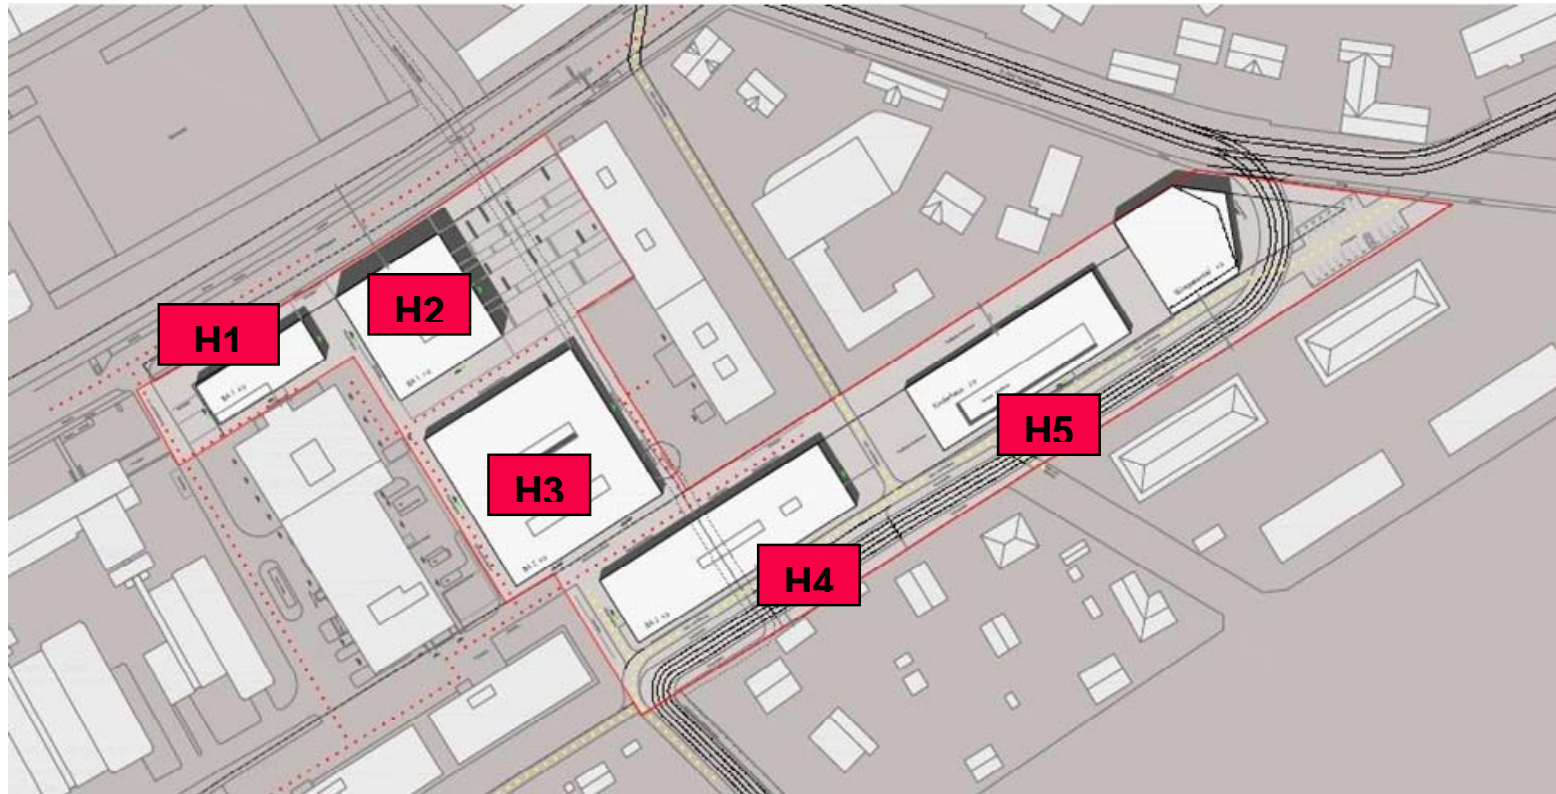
Grundrissplan des Produktionstechnikzentrum Inffeldgasse
